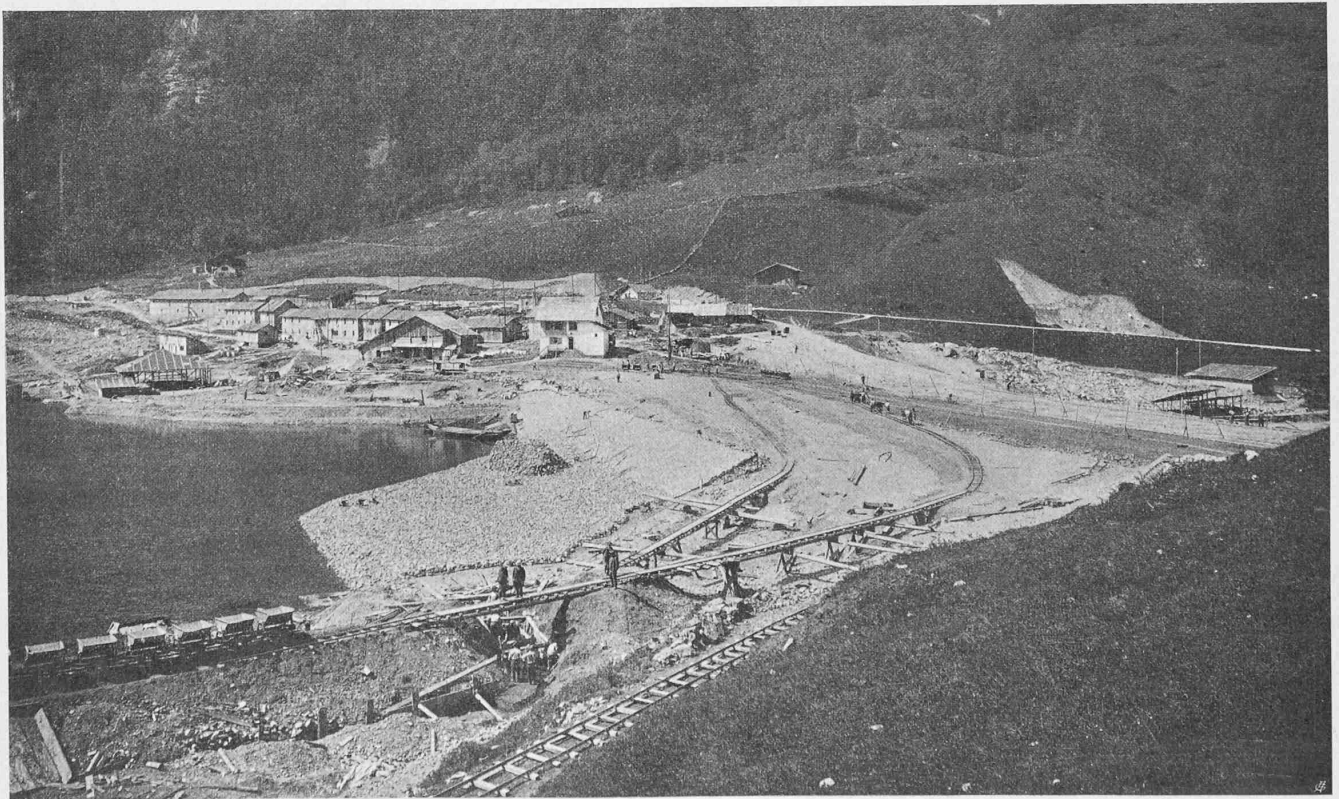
Baustelle Rodanenberg von Süden (Juni 1909); im Vordergrund Anschluss des Dammes an den rechtsseitigen Abhang.
